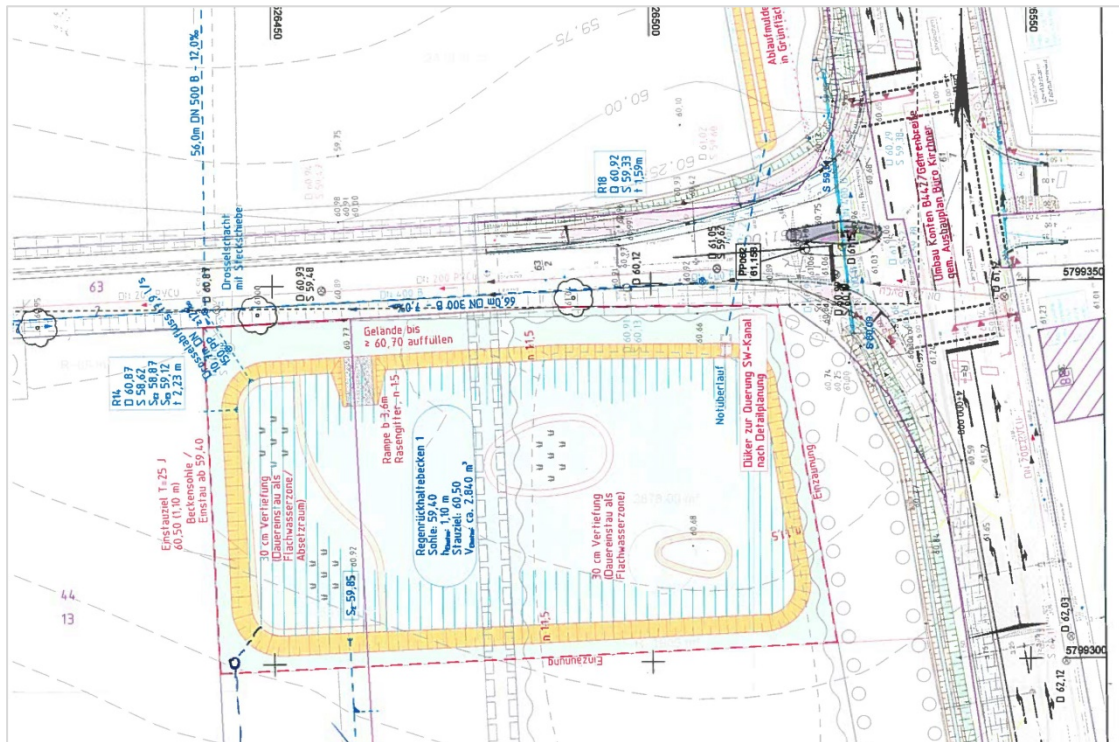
Lage des Regenrückhaltebeckens (Quelle: Ingenieurbüro Kruse, Entwurf Entwässerung Gewerbegebiet Gehrenbreite, Auszug, Stand: 12.02.2019)
